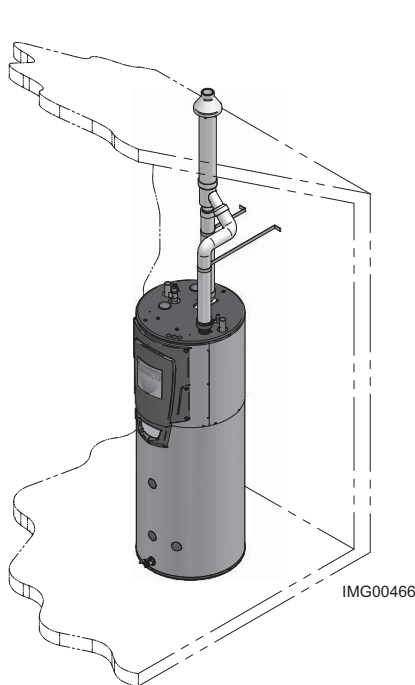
Terminaison verticale concentrique en PVC/CPVC - Voir page 32 pour d'autres détails
